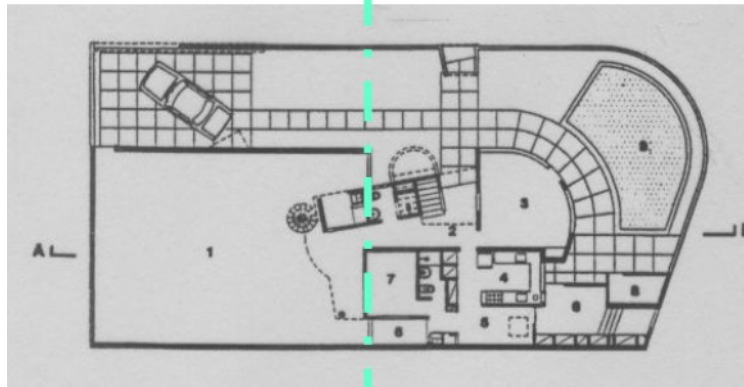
Planta do Primeiro Piso: Simetria e Equilíbrio
